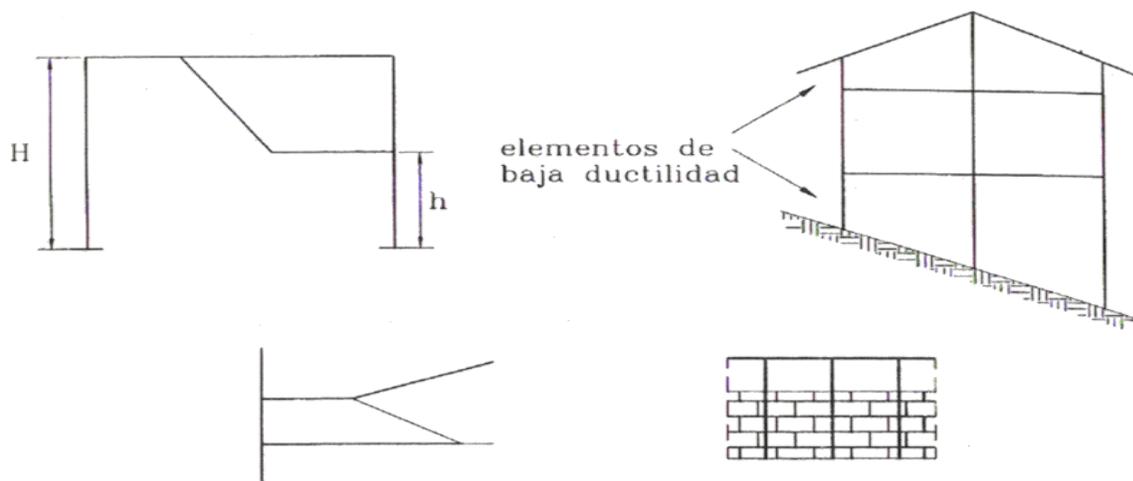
Ejemplos de edificios con elementos de baja ductilidad.
